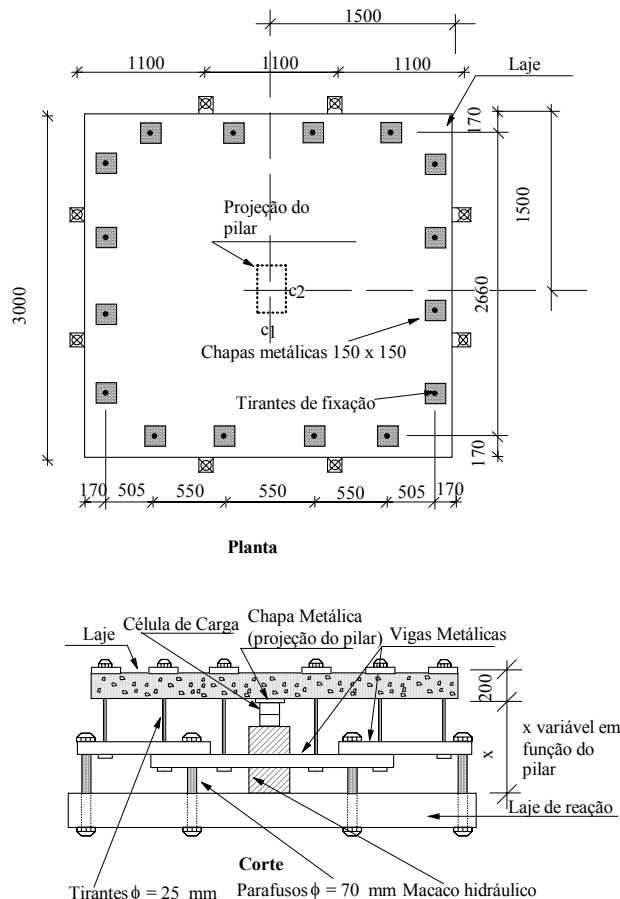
Esquema de ensaio (dimensões em mm)
